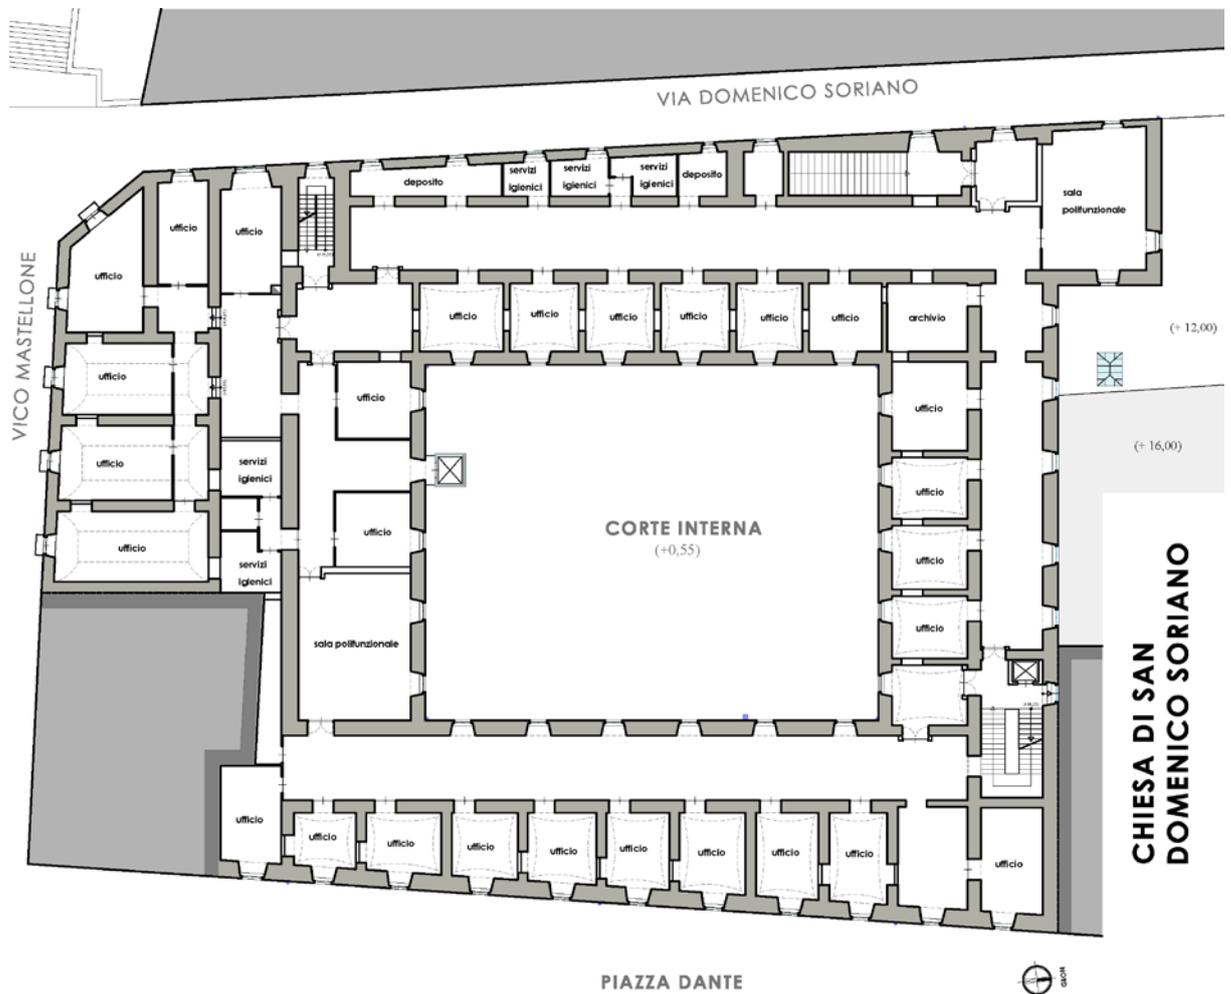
Indicazioni progettuali: Pianta Piano Terzo
